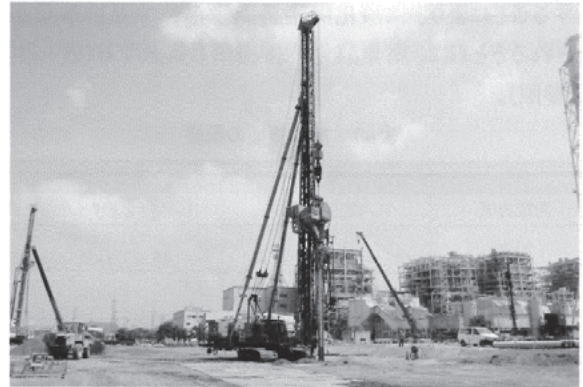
サンドコンパクションパイル (動的工法) 施工状況
